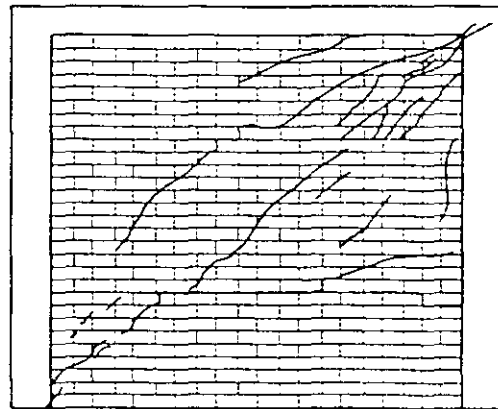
Ensaye en voladizo de un muro de mampostería confinada (Meli, 1979).
